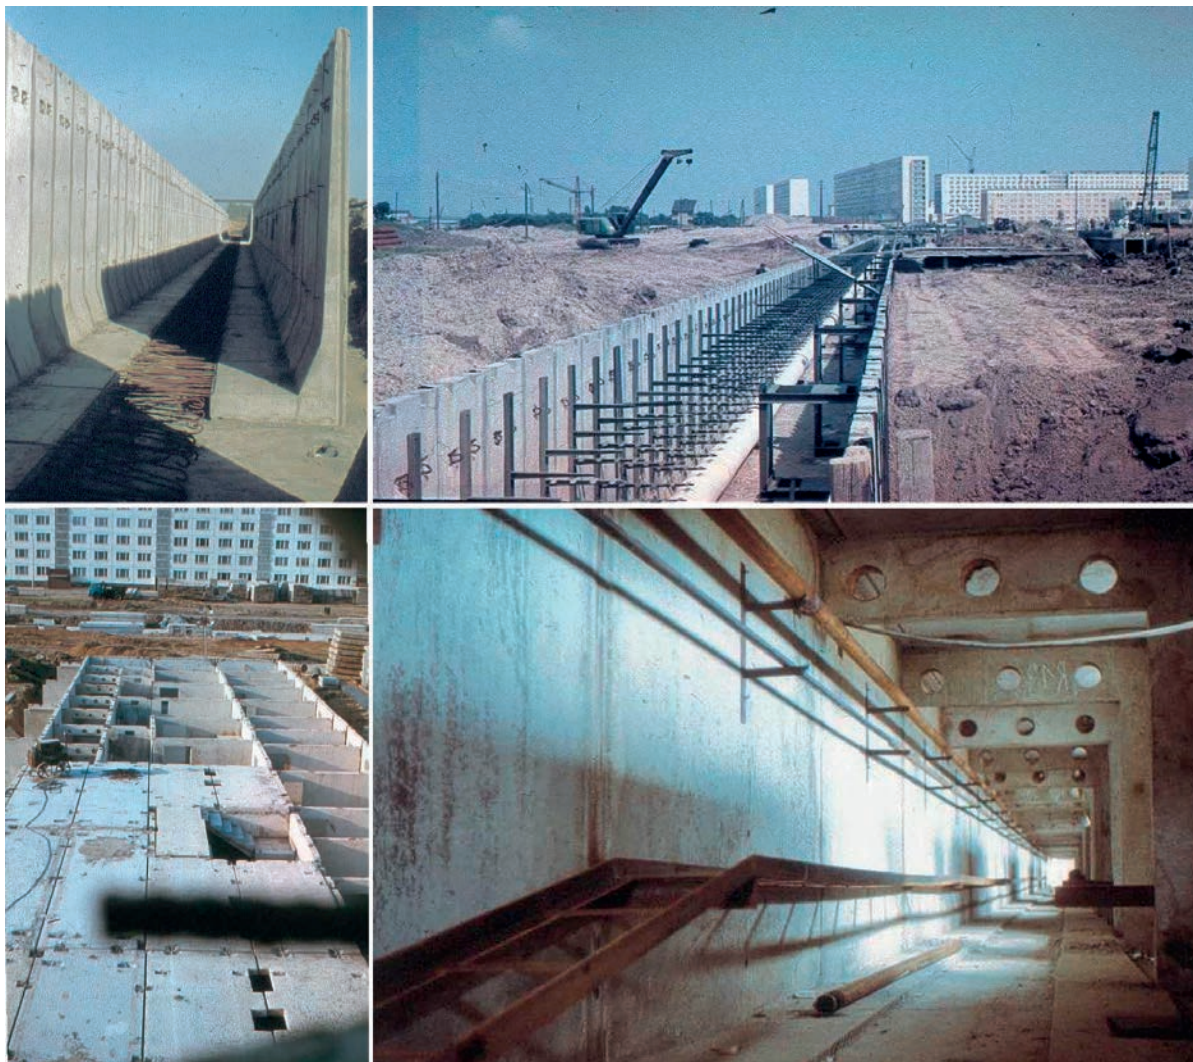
Sammelkanal Halle-Neustadt – Kanalkonstruktion; Sammelkanal im Bau; Gebäude-Leitungsgang – Kellergeschoss, links im Bild Leitungsgang; Gebäude-Leitungsgang – Blick in den Leitungsgang
